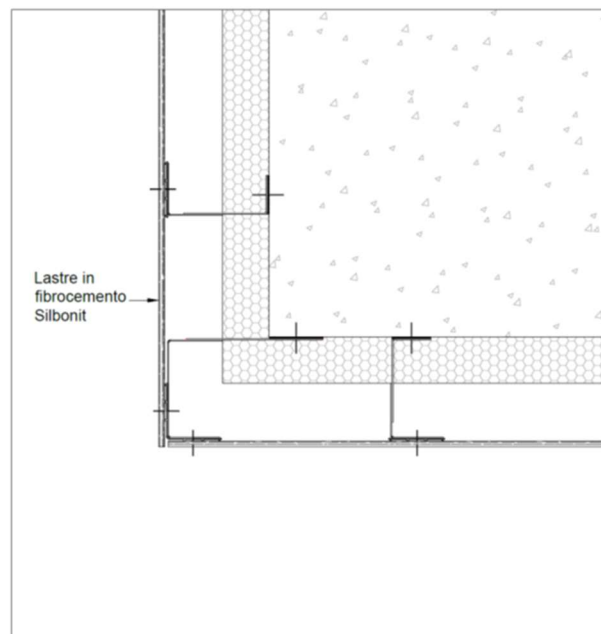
Esempio di una sezione orizzontale tipo del pacchetto di facciata ventilata in corrispondenza di un angolo esterno con giunto verticale aperto tra lastre del rivestimento. Sottostruttura di alluminio.
